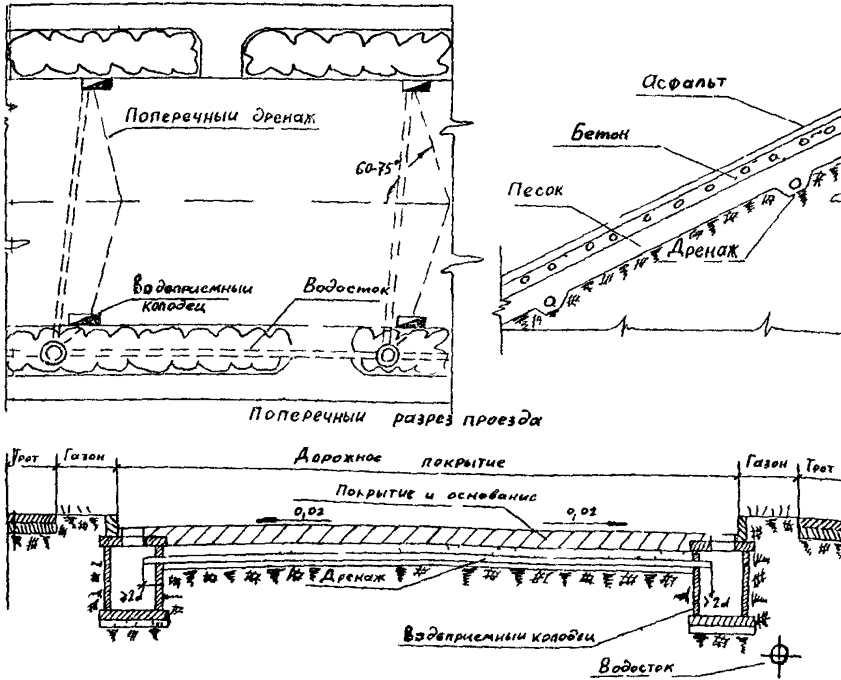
Конструкция дренающего слоя городских улиц с поперечными прорезями
